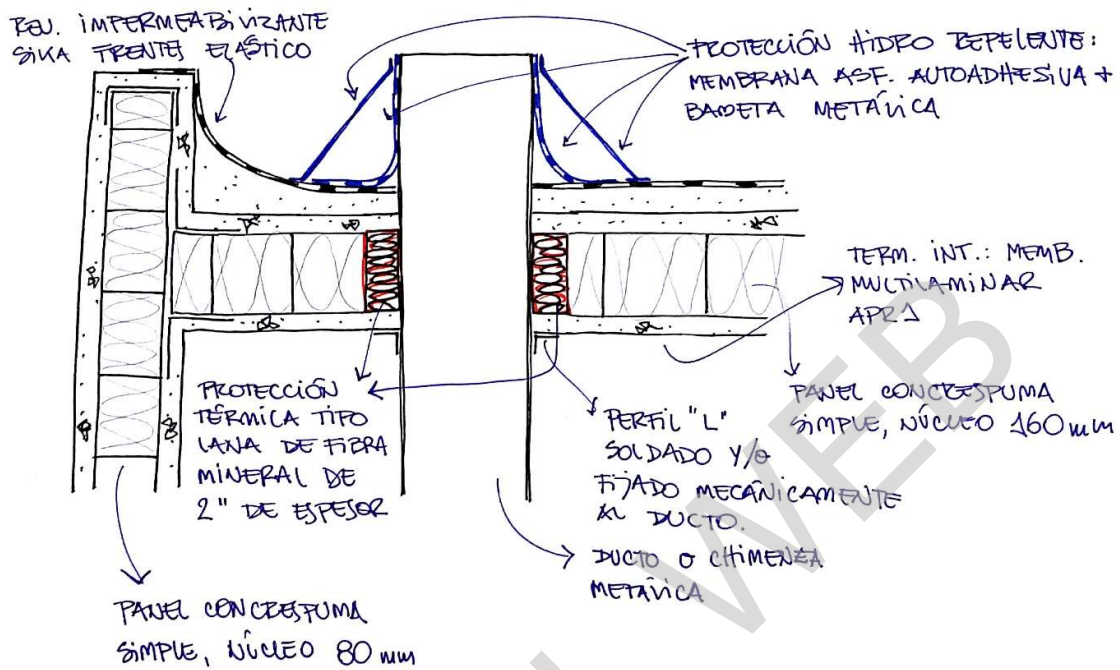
Encuentro de chimenea metálica con techo CONCRespuma® (croquis ilustrativo)
